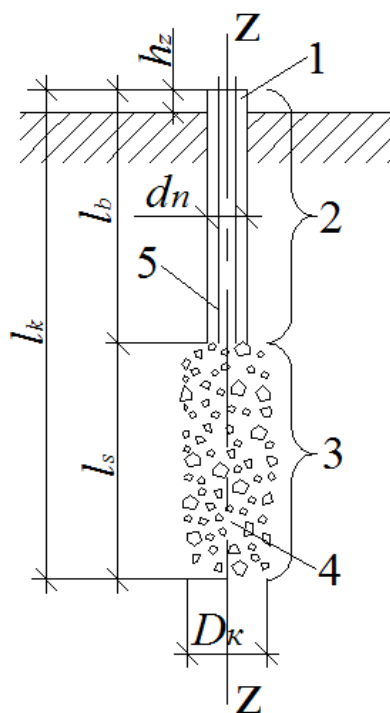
Конструктивная схема тела НРСк: 1- оголовок; 2- бетонная с армированием часть; 3- щебенистая часть сваи; 4- уплотненный щебнем забой; 5- армирование сваи.
